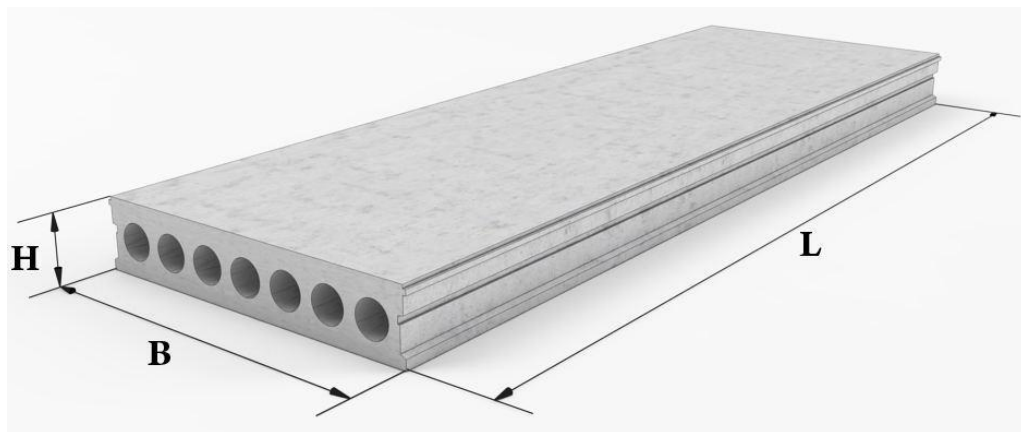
Багатопустотна плита перекриття ПК 63.12-8
